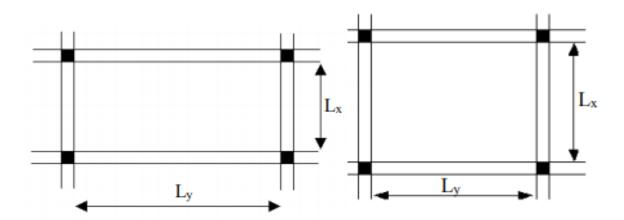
Dimensions d'un panneau de dalle pleine
